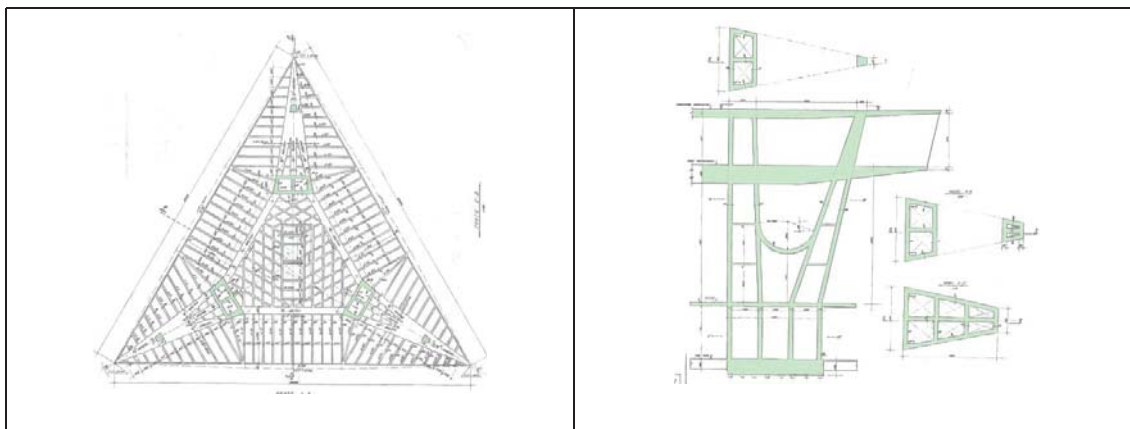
Planta de forma da cobertura e cortes da estrutura (fonte ArPDF)
